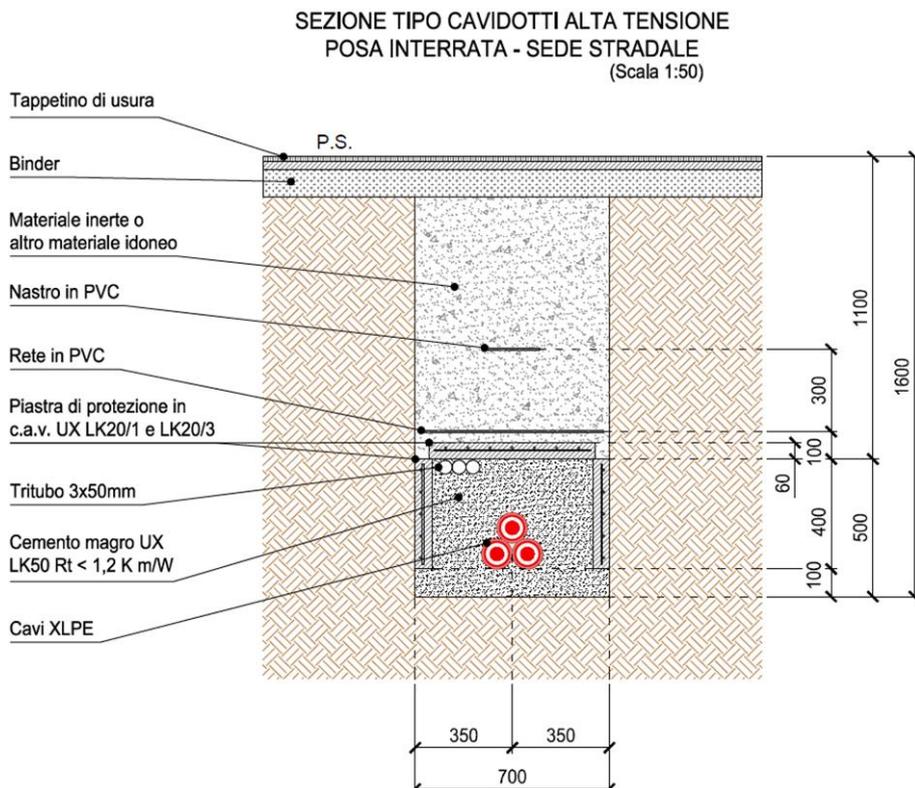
Sezione tipica di posa dell'elettrodotto interrato. Elaborazione iLStudio
